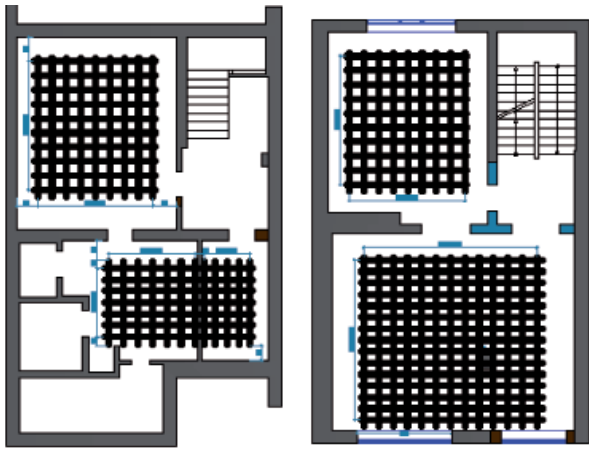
Схема усиления плит перекрытий жилого дома на просп. Достык
